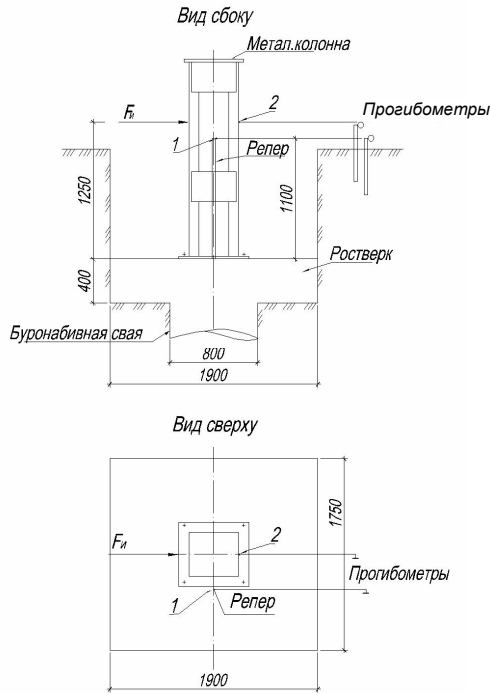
Схема испытания системы «буронабивная свая – ростверк – металлическая колонна» горизонтальной нагрузкой
